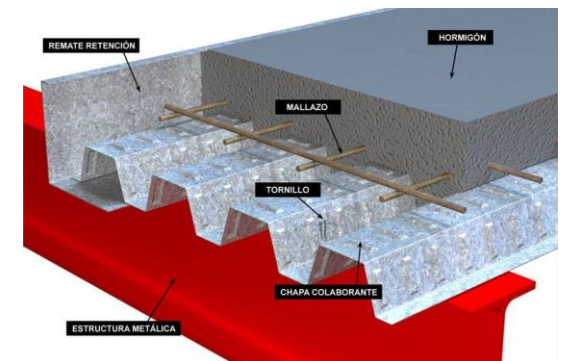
7. Losa Mixta Detalle Constructivo
